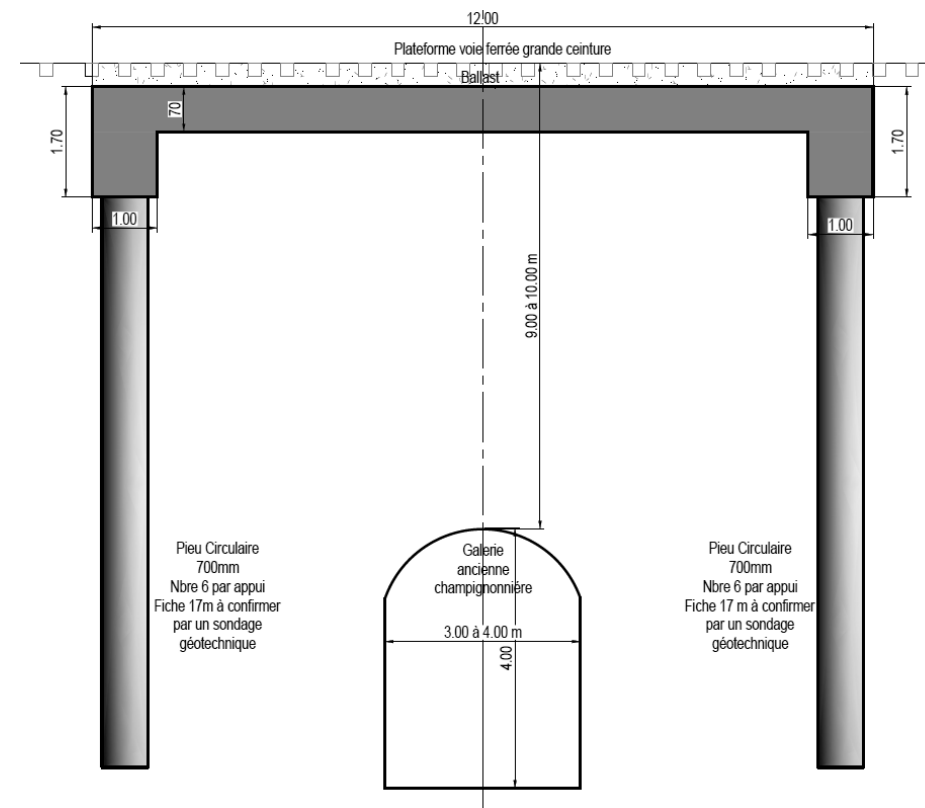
Ouvrage de franchissement de la galerie (coupe A)
